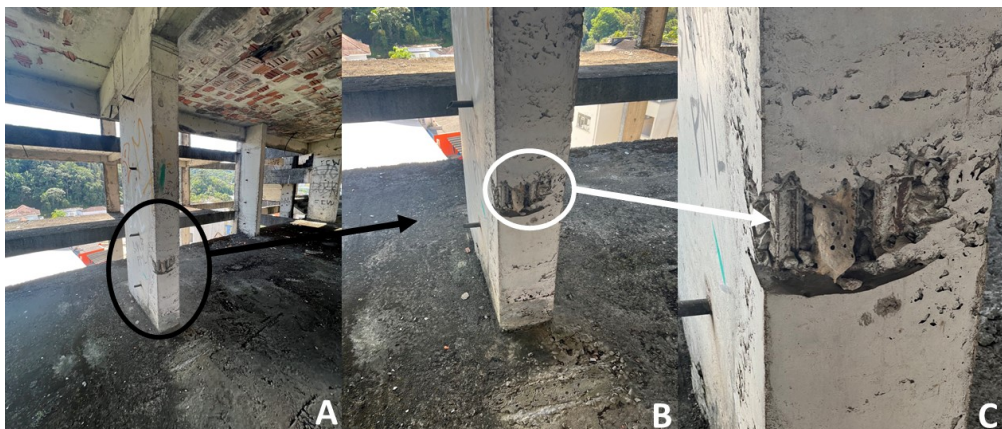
Pilar P18: (A e B) localização; (C) pormenor.
